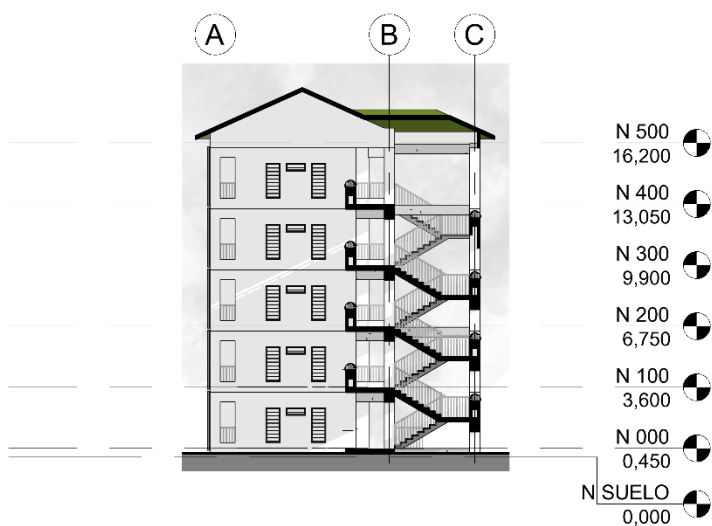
SECCIÓN TRANSVERSAL EDIFICIO 3 | Elaborado por: El autor
